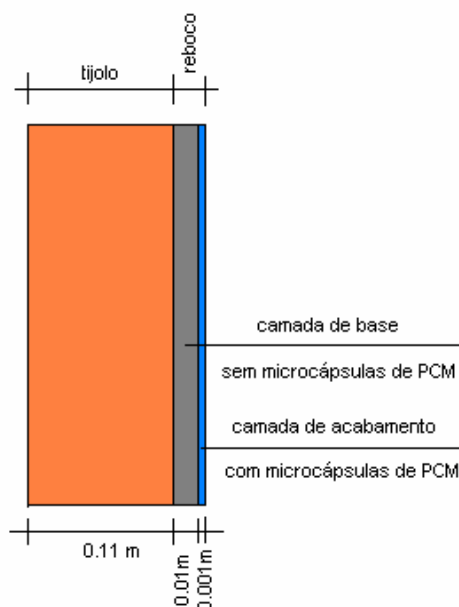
Esquema de uma secção de parede de tijolo revestida numa das faces com reboco.
